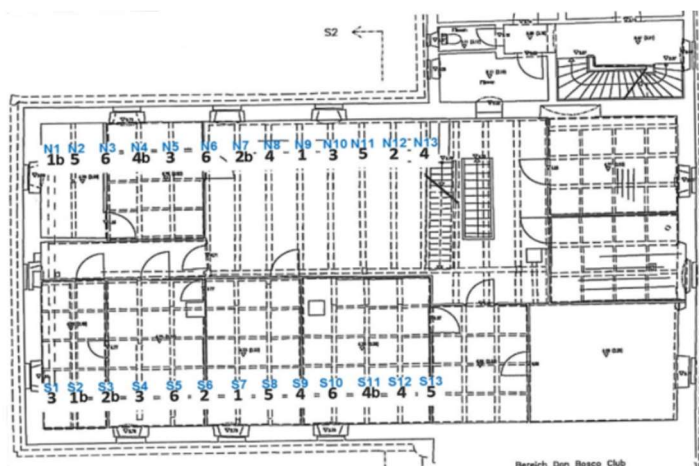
Lageplan der Deckenbalken und deren Sanierungsmaßnahmen
